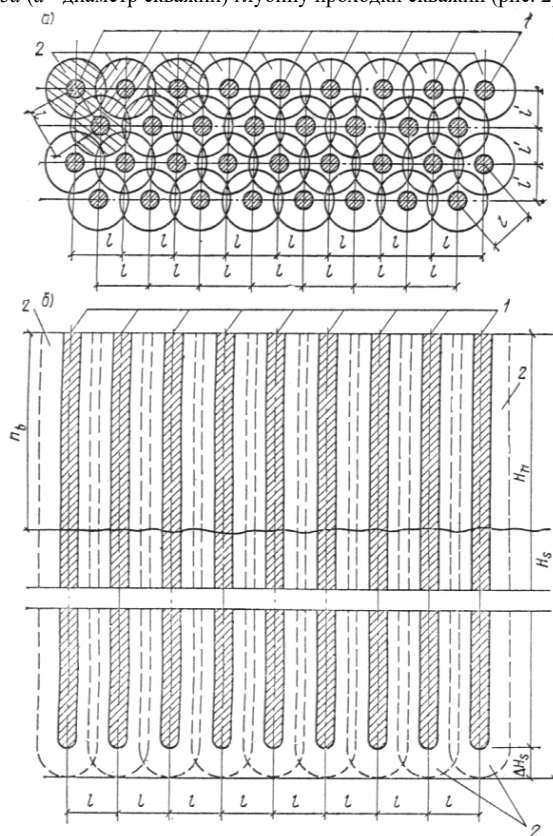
План расположения грунтовых свай (а) и поперечный разрез уплотненного массива (б) 1 - грунтовые сваи; 2 - уплотненные зоны вокруг грунтовых свай.
